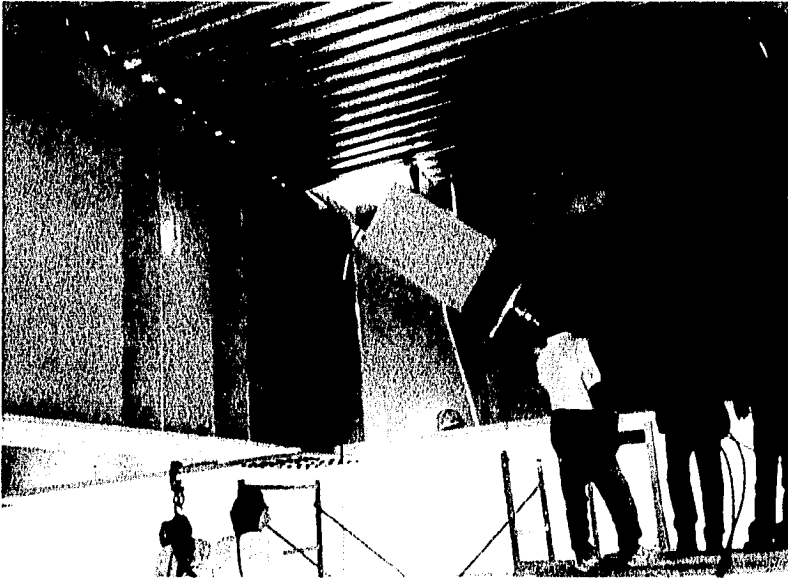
Tensado inicial del primer torón (derecho).
